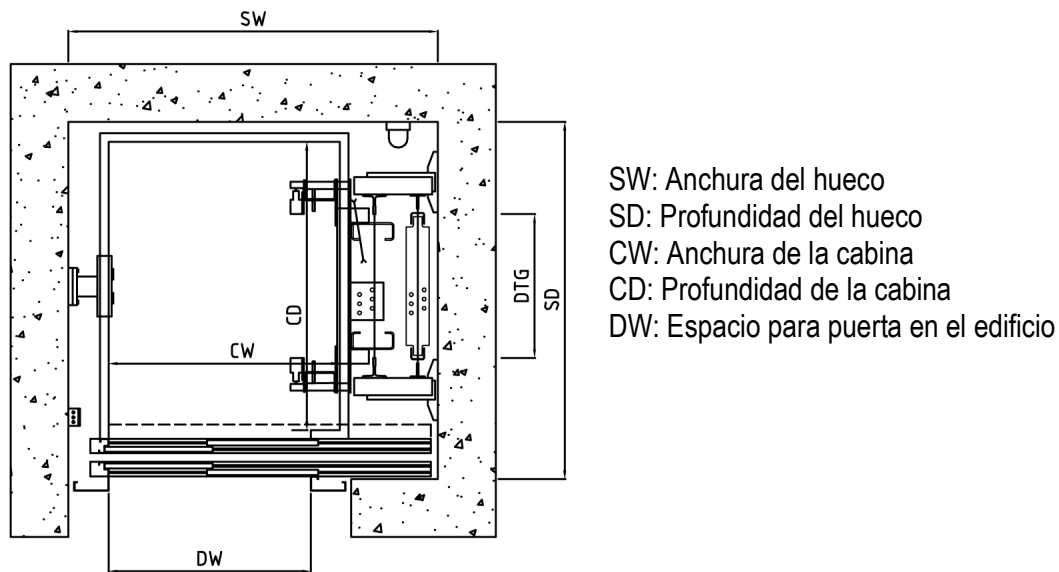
Primer diseño a partir de las dimensiones del hueco.
